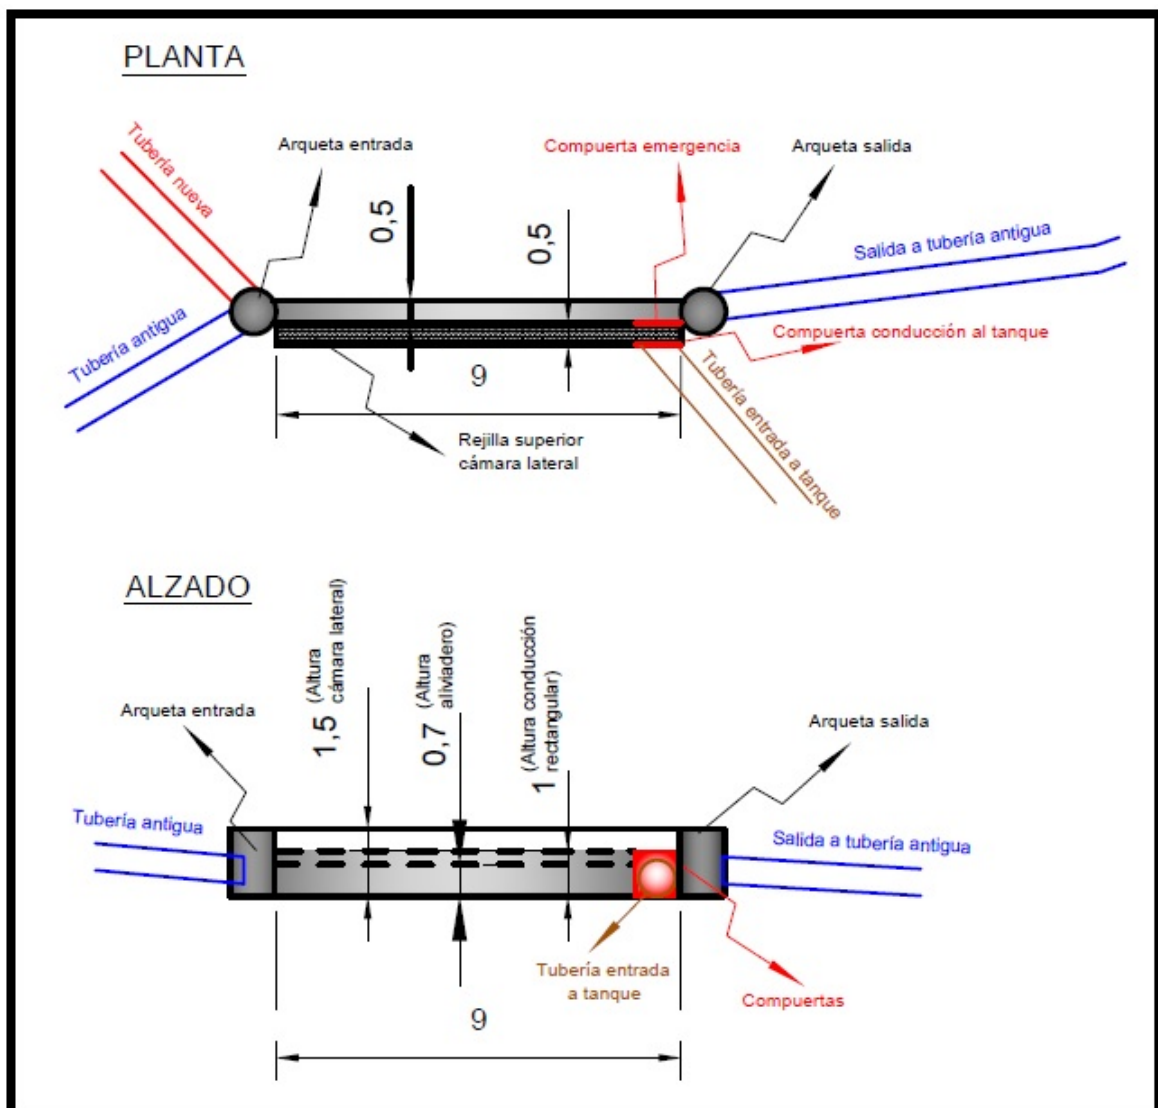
Planta y alzado del bypass de aliviadero y conducción al tanque de tormentas con cotas en m.
